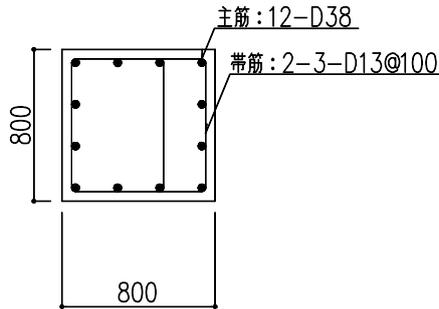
柱の配筋図 (地下2階, X6a/YP 通り, 柱頭部) (単位:mm)
